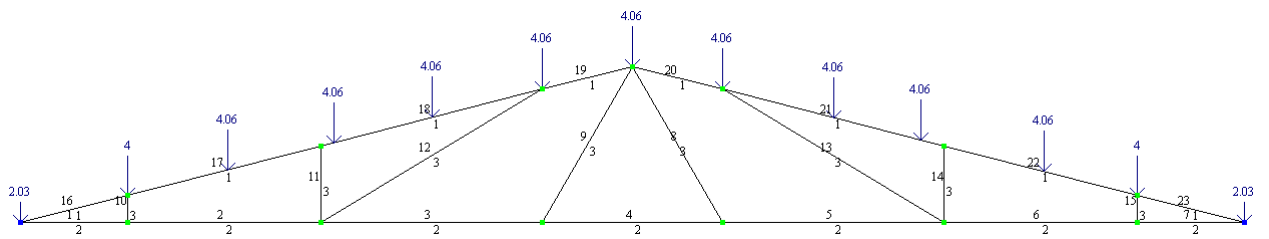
Сосредоточенная нагрузка в верхних узлах фермы (от веса прогонов и покрытия)
